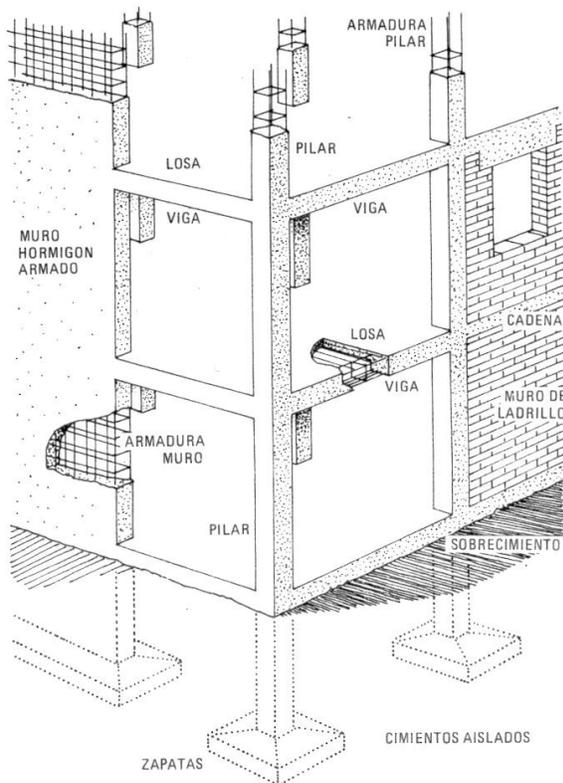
Principales elementos de una estructura resistente de hormigón armado, en un diseño de tipo tradicional.
